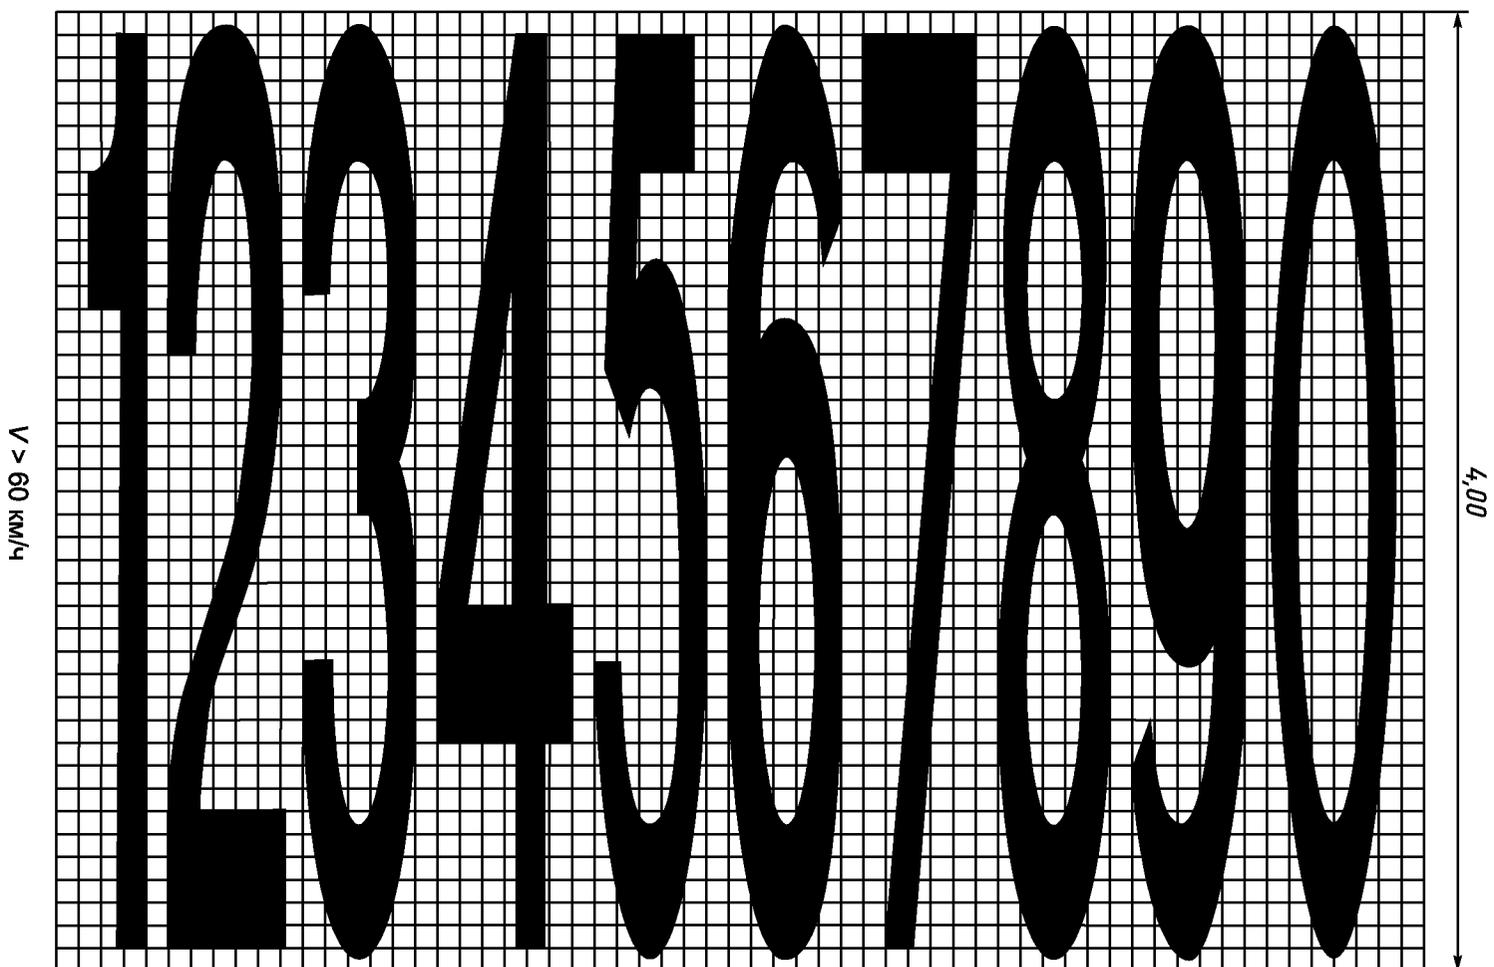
Форма, расположение и размеры цифр разметки типа 1.22
